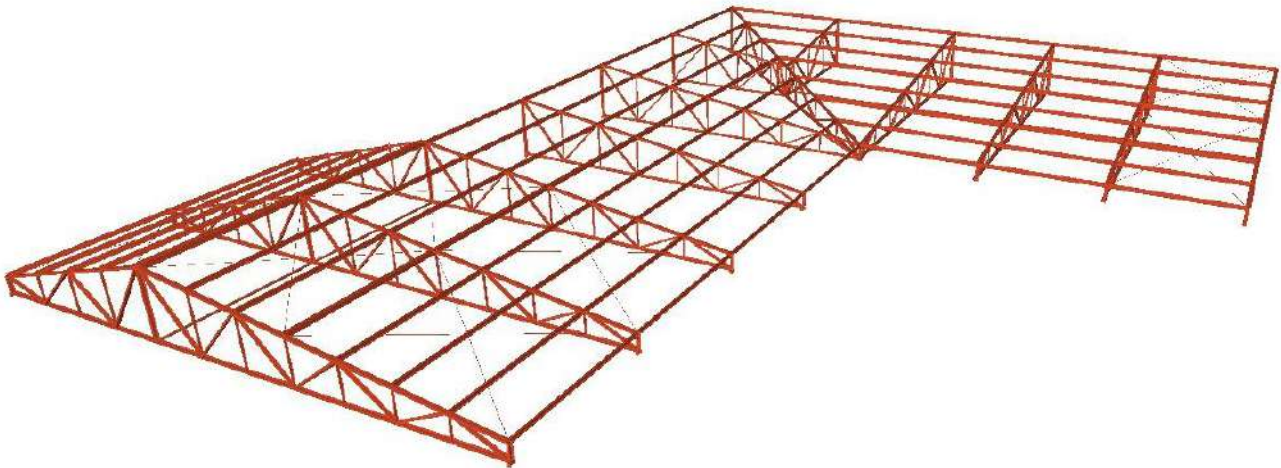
Estructura Metálica. Fuente: Imagen Cype 3D.
